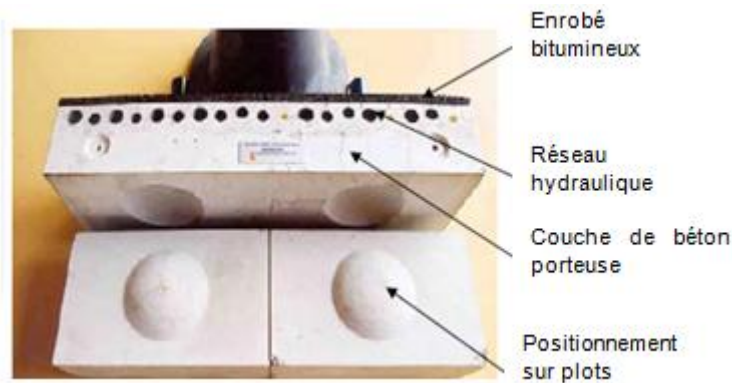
Coupe de la chaussée dalles béton + enrobé bitumineux drainants
